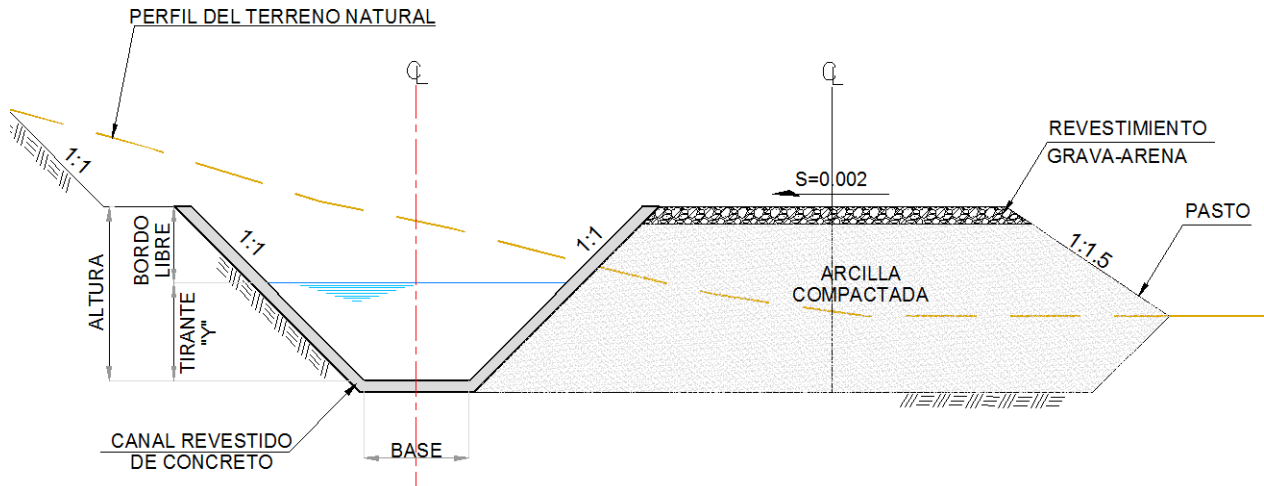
Sección de canal de conducción recargado en borde de protección.
